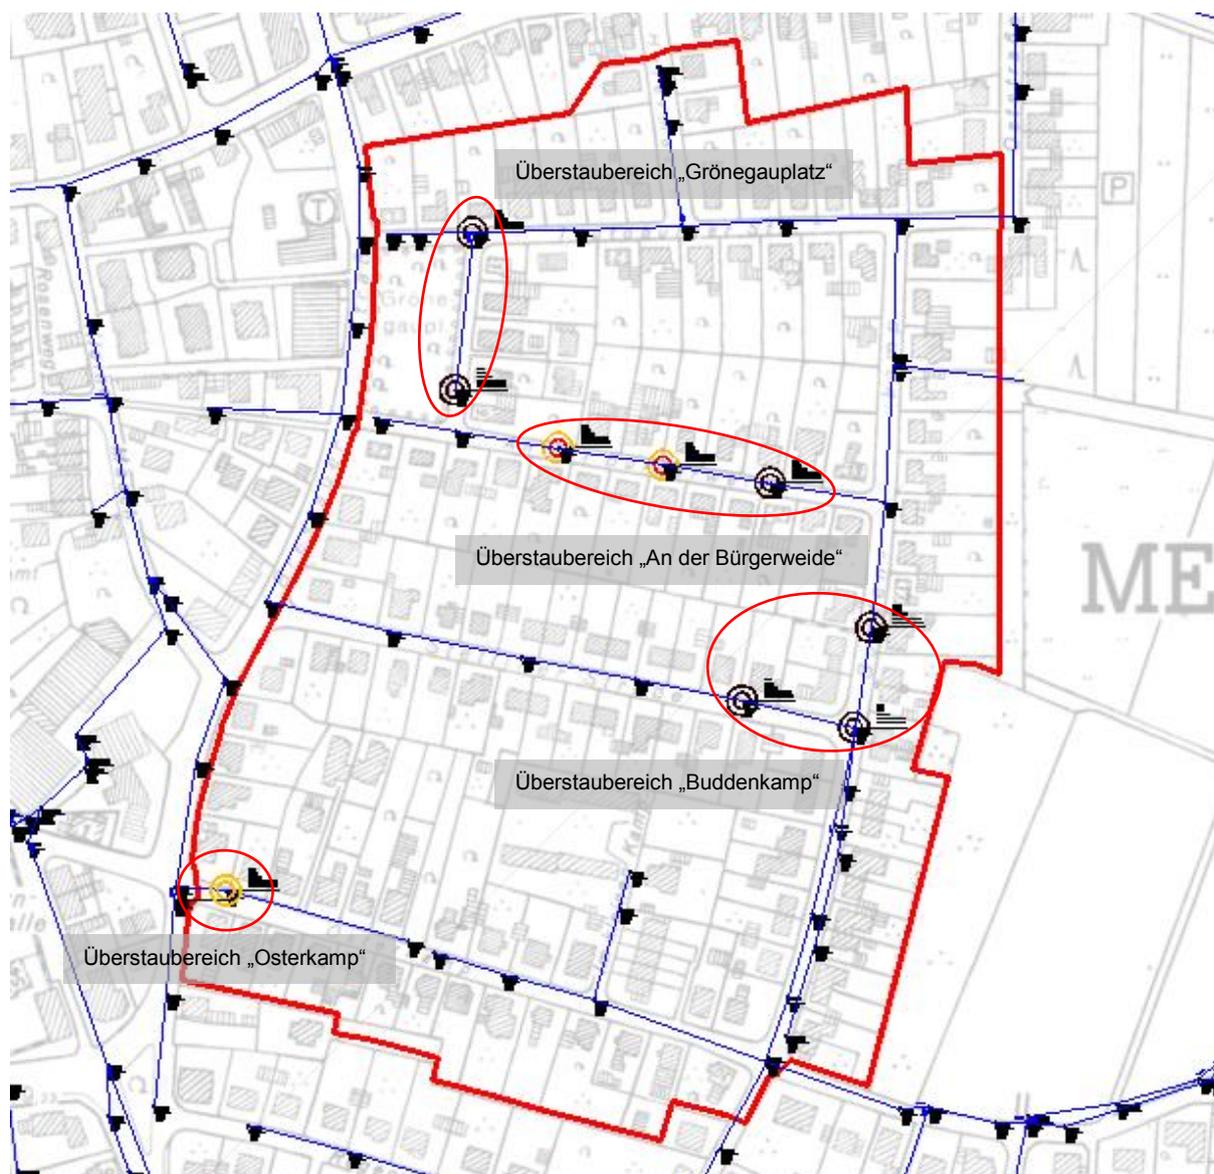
Lageplanausschnitt Überstaubereiche Planungszustand (ohne Retention)
